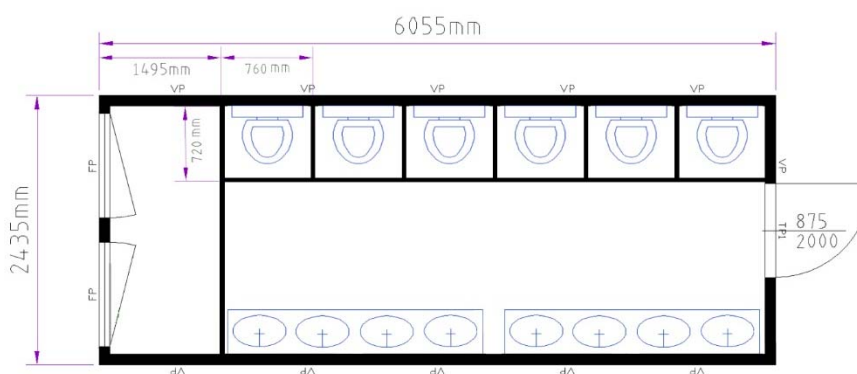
Planta del contenedor de 20 pies. Fuente: Descripción técnica para MÓDULOS de la empresa CONTAINEX.
